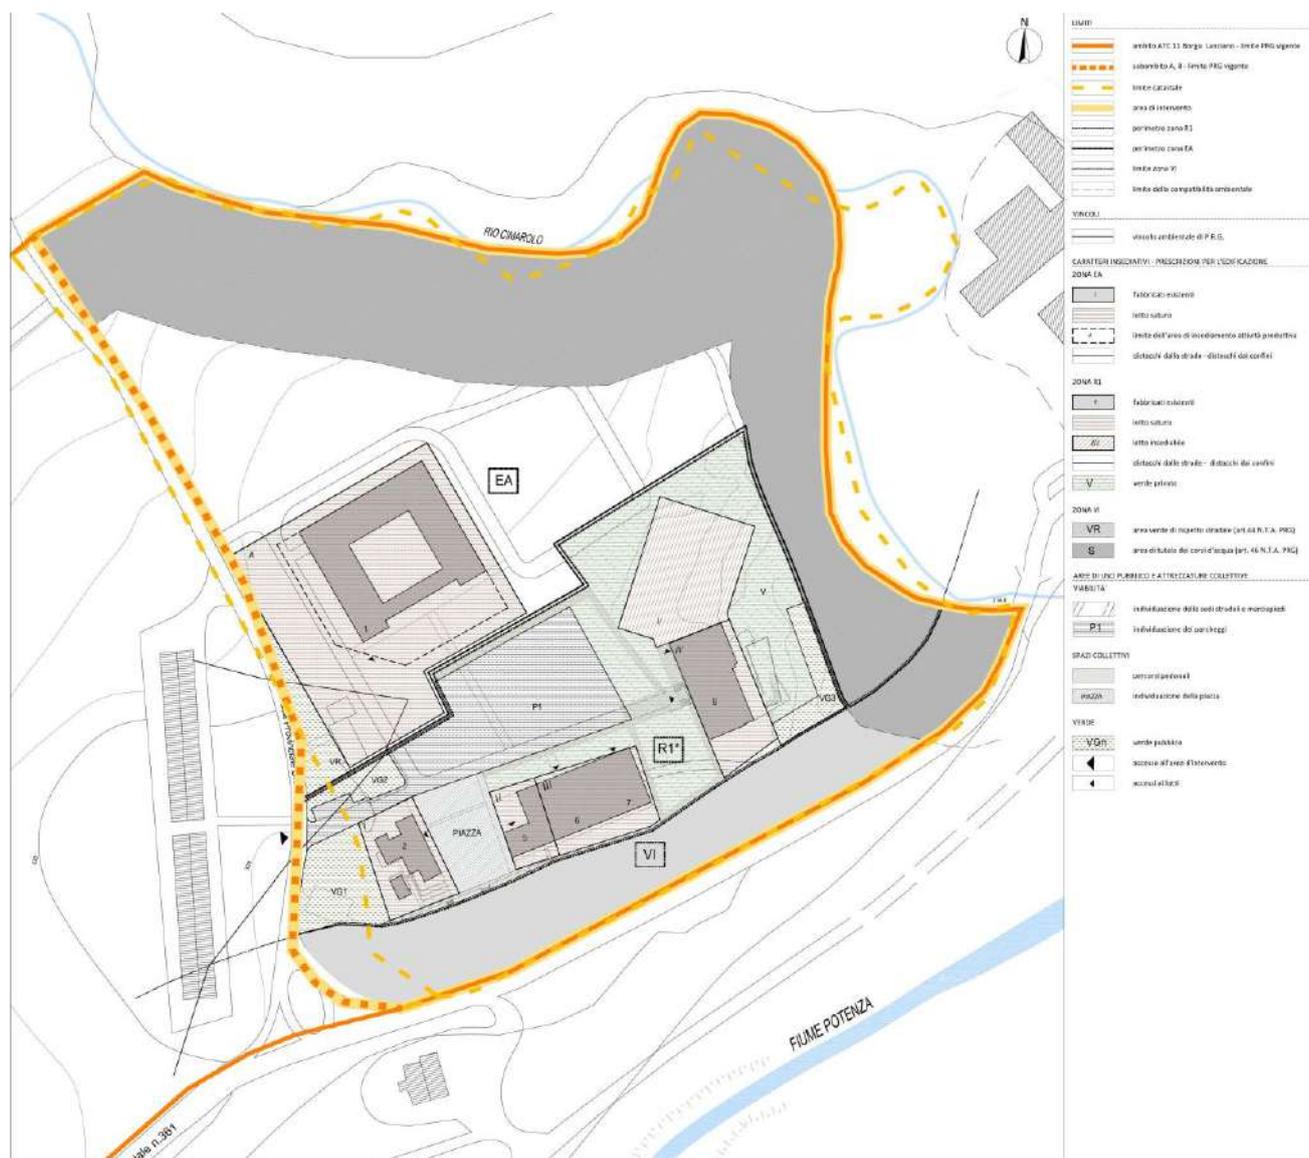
Variante al piano attuativo dell'insediamento in area R1* Piani di Lancianello - Stralcio Tav. VU02a.2 Planimetria normativa
